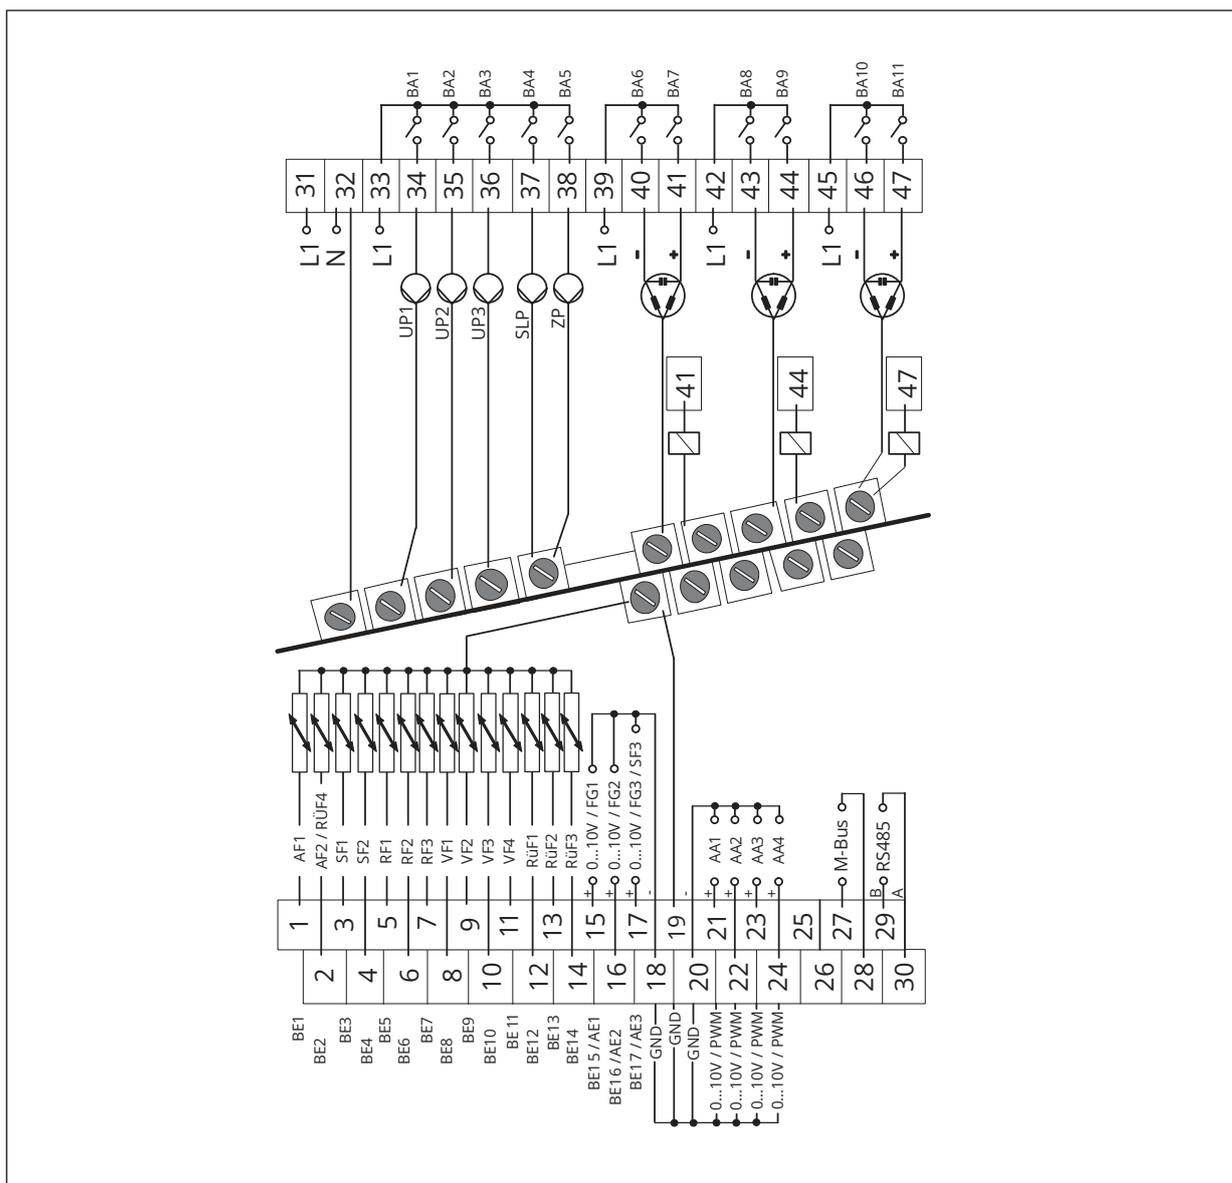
Collegamento elettrico TROVIS 5578-1113
